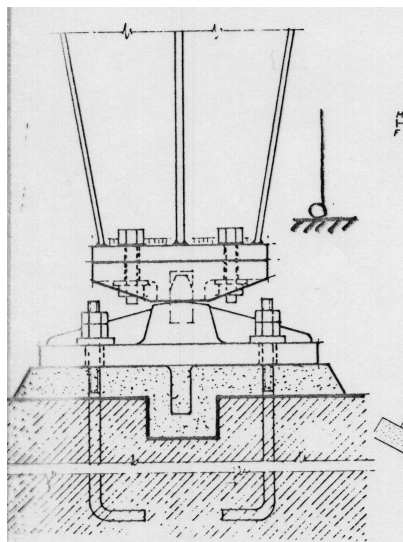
Esempio di collegamento cerniera tra piede pilastro e fondazione.
